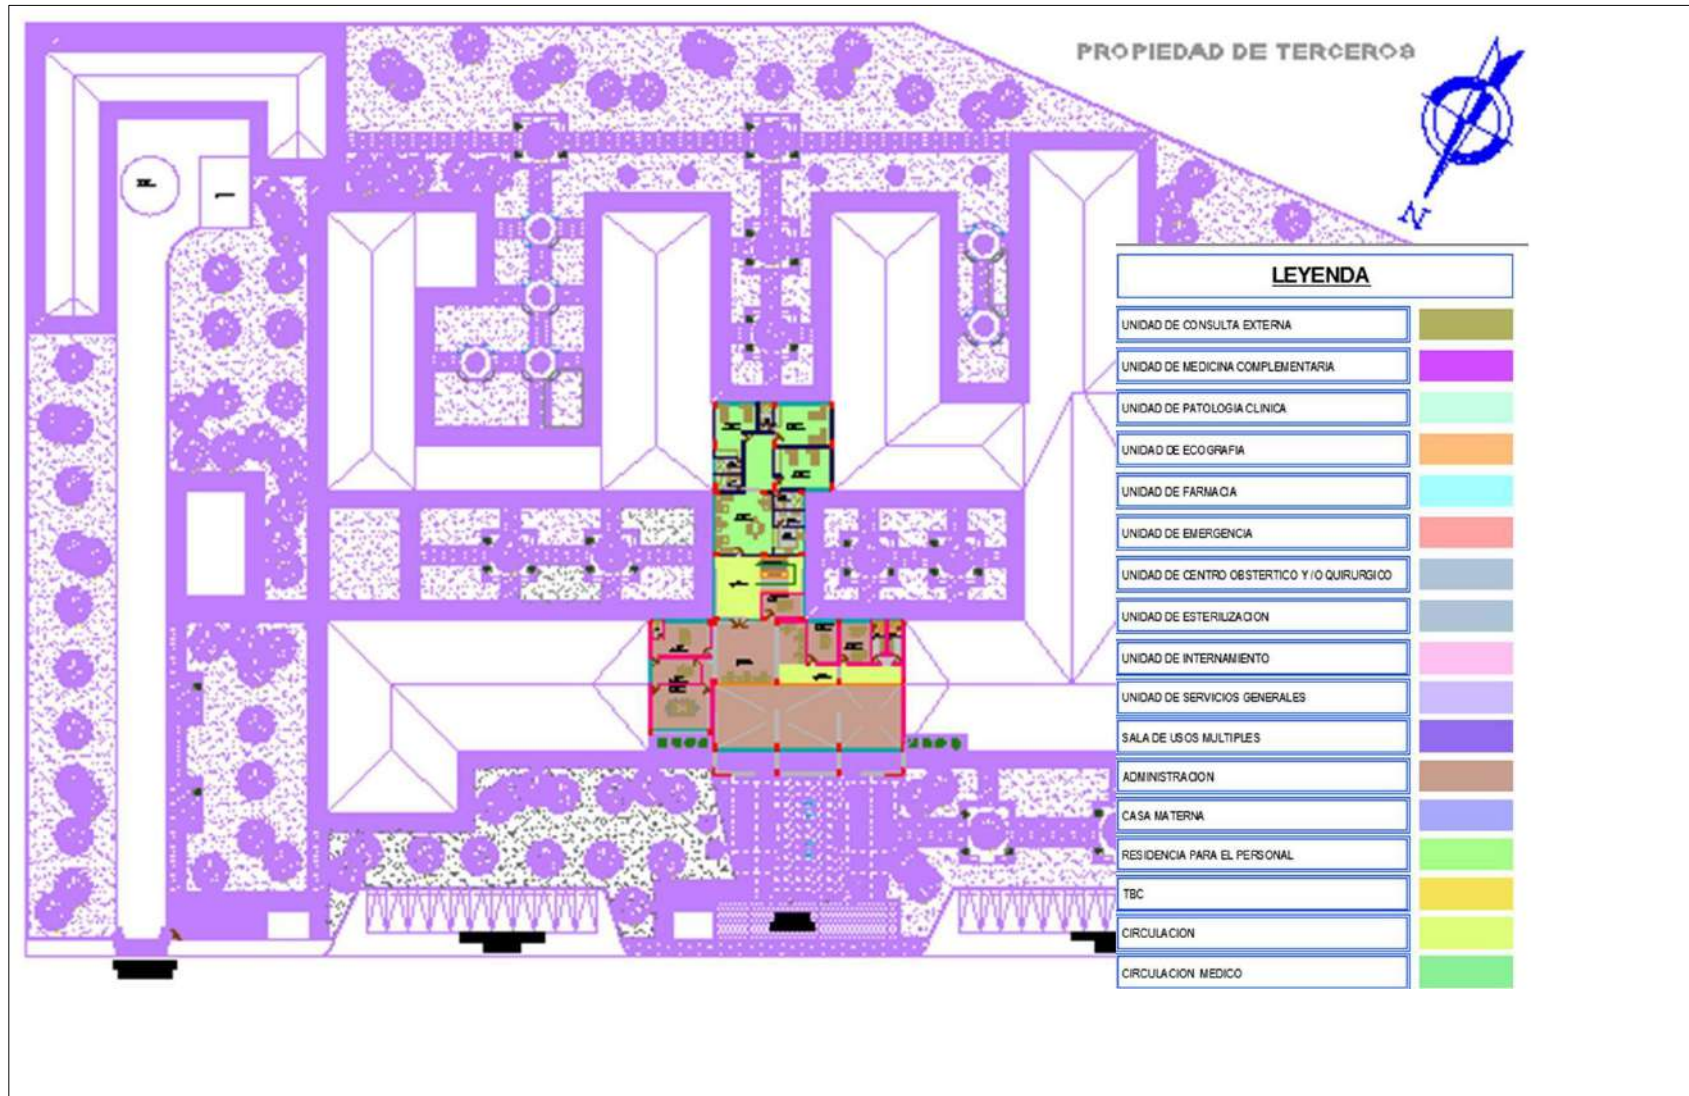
Zonificación 2° planta; Fuente: elaboración propia
